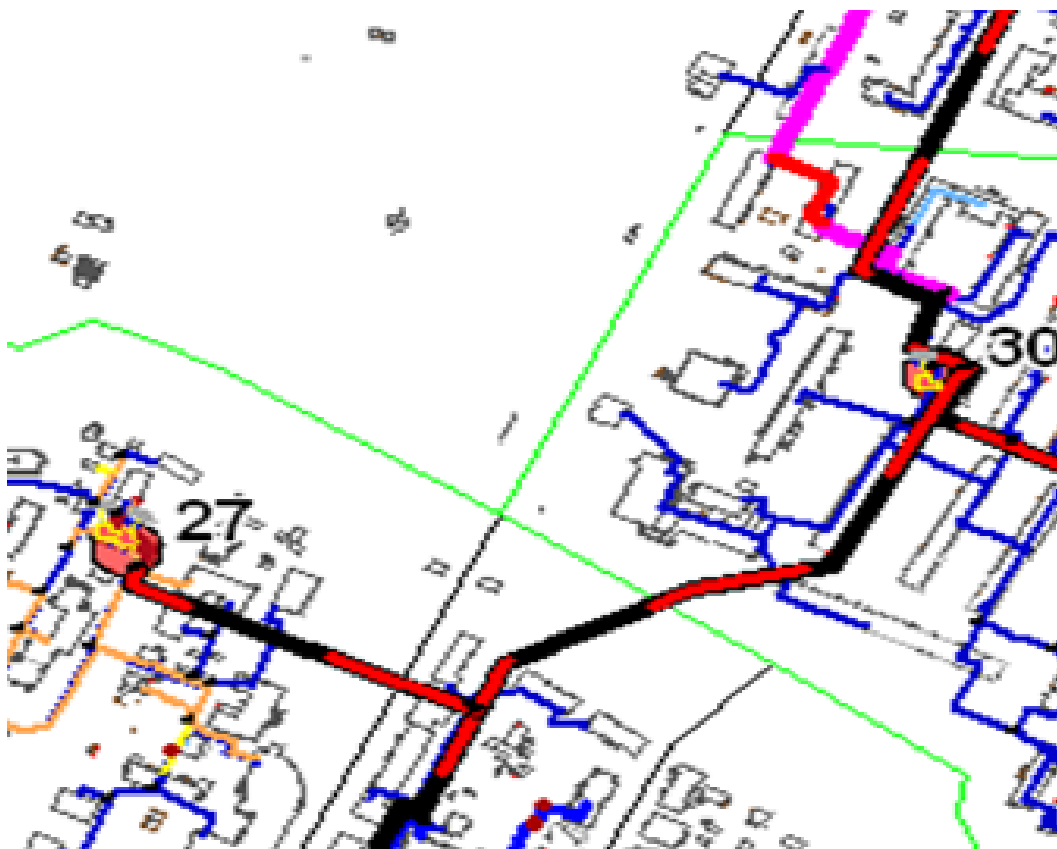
Схема прокладки трубопровода от котельной №27 до котельной №30
